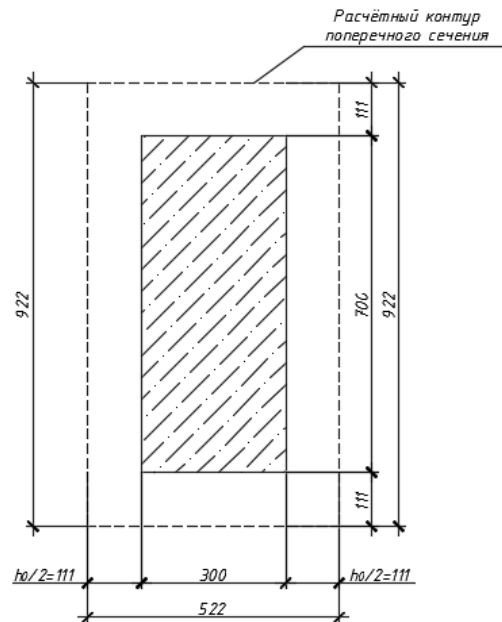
Расчётный контур поперечного сечения перекрытия
